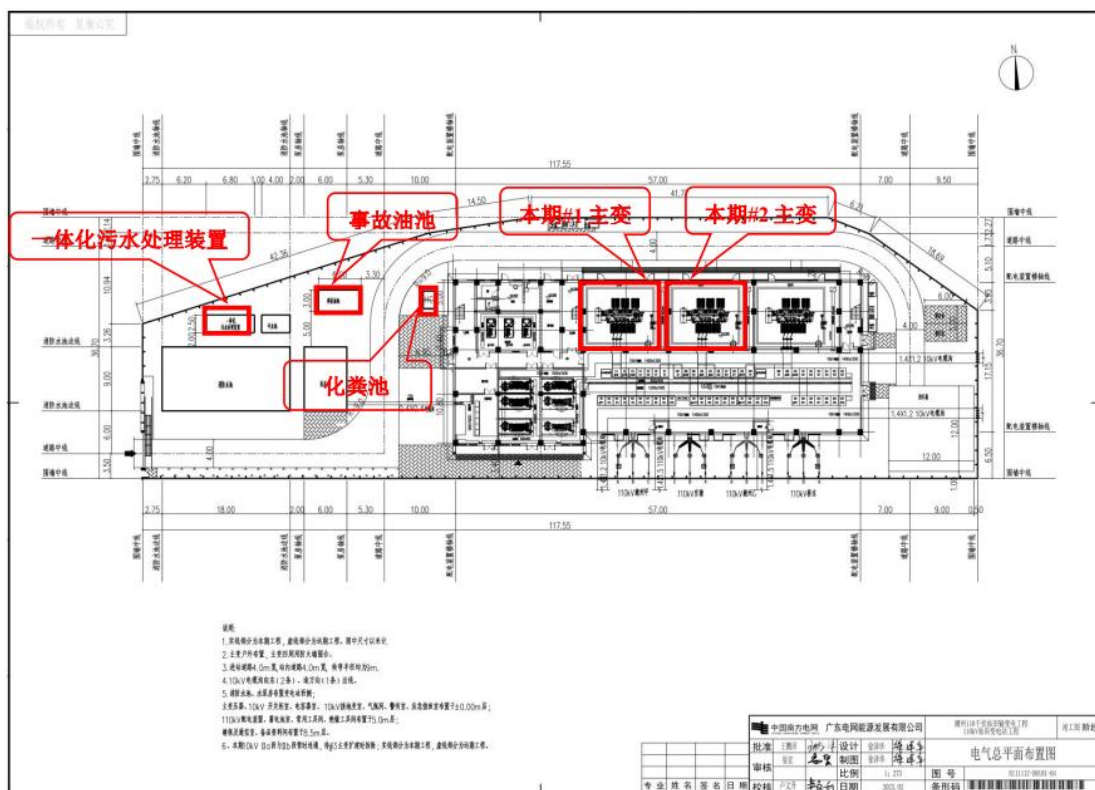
潮州 110kV 半岛站总平面布置示意图
